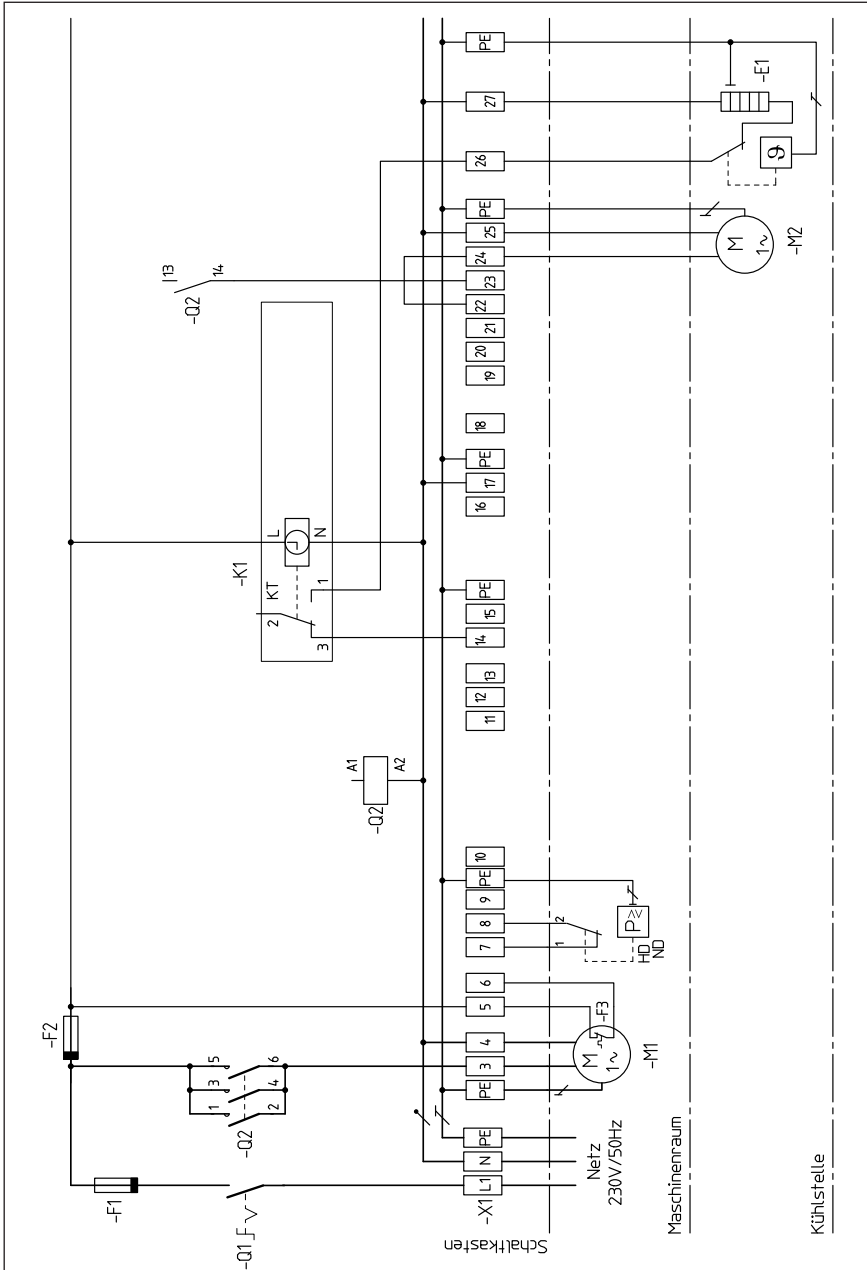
Stromlaufplan/Verdrahtungsplan
